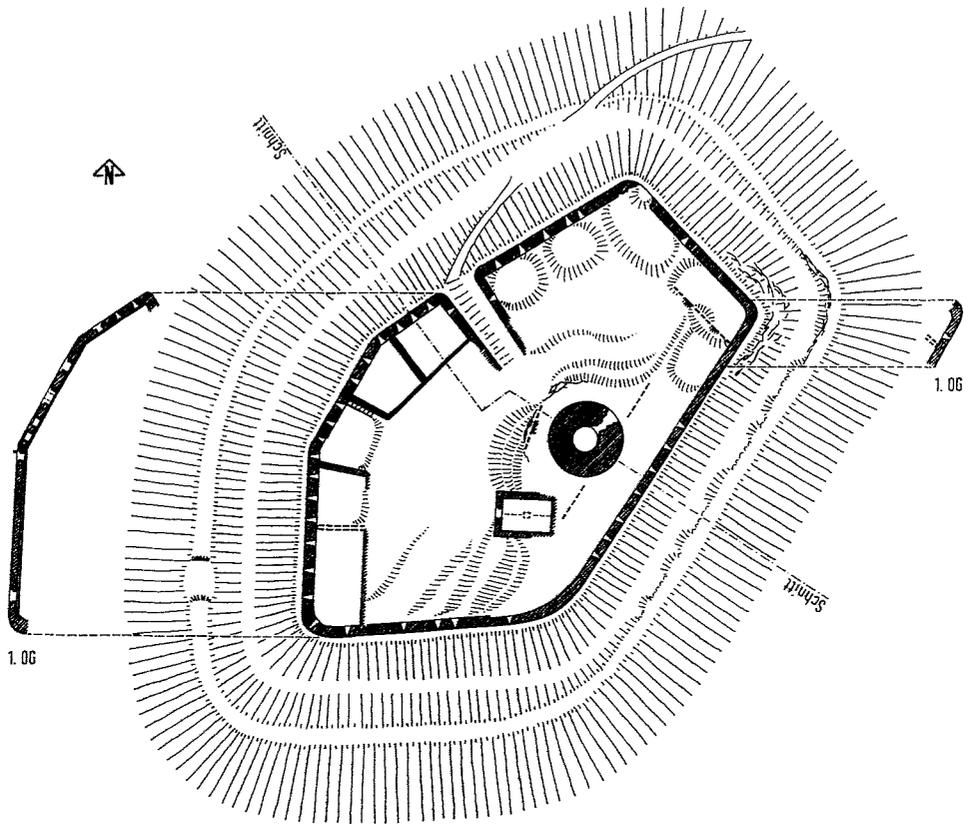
Pflixburg bei Colmar, Baualterplan Erdgeschoß und 1. Obergeschoß (Erstbau um 1212-19 eng schraffiert, Umbauten weit schraffiert; Skizze nach Luftaufnahme: Biller)
